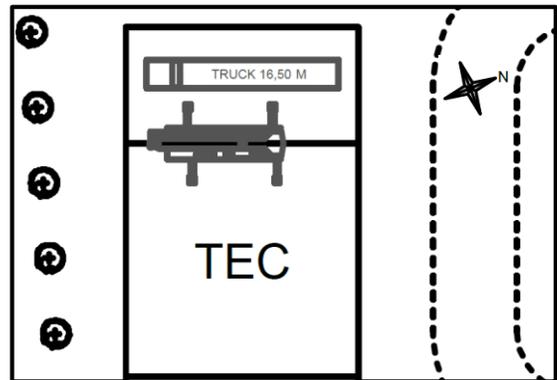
Lote del TEC Team para el ensamblaje de Tropika
